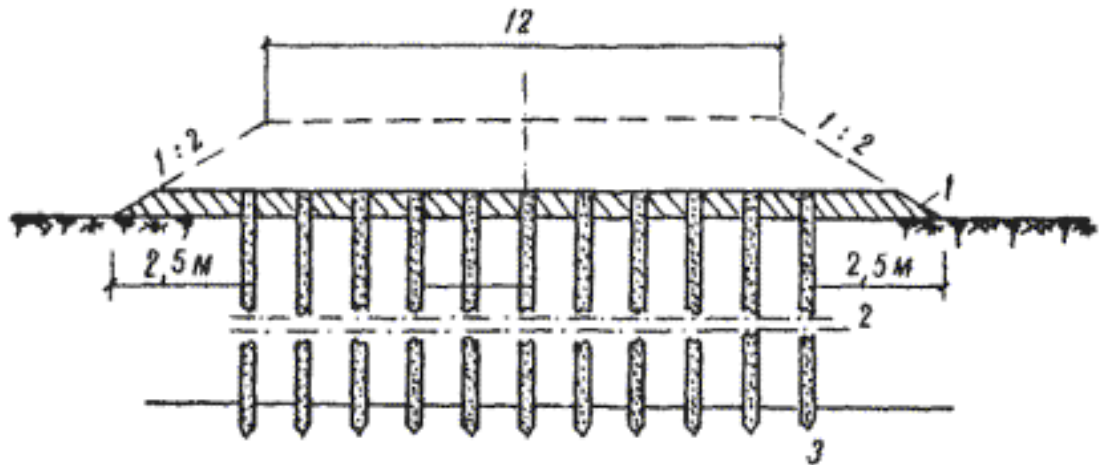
Поперечний переріз ґрунтового привантаження з піщаними палями: 1 – робоча платформа; 2 – слабкий водонасичений ґрунт; 3 – наступний шар ґрунту
